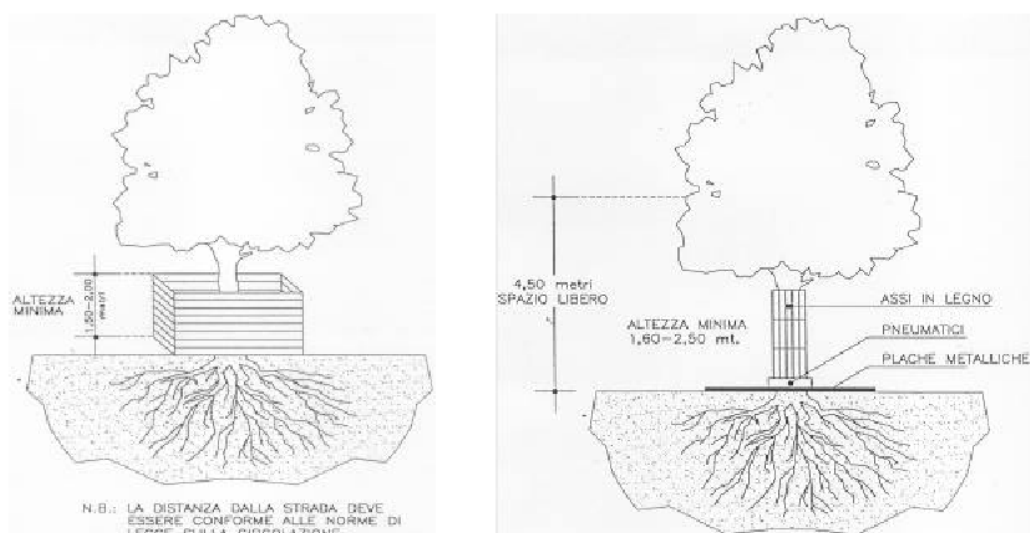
Protezione dell'albero attraverso la delimitazione dell'area minima di rispetto per alberature stradali con poco spazio.
